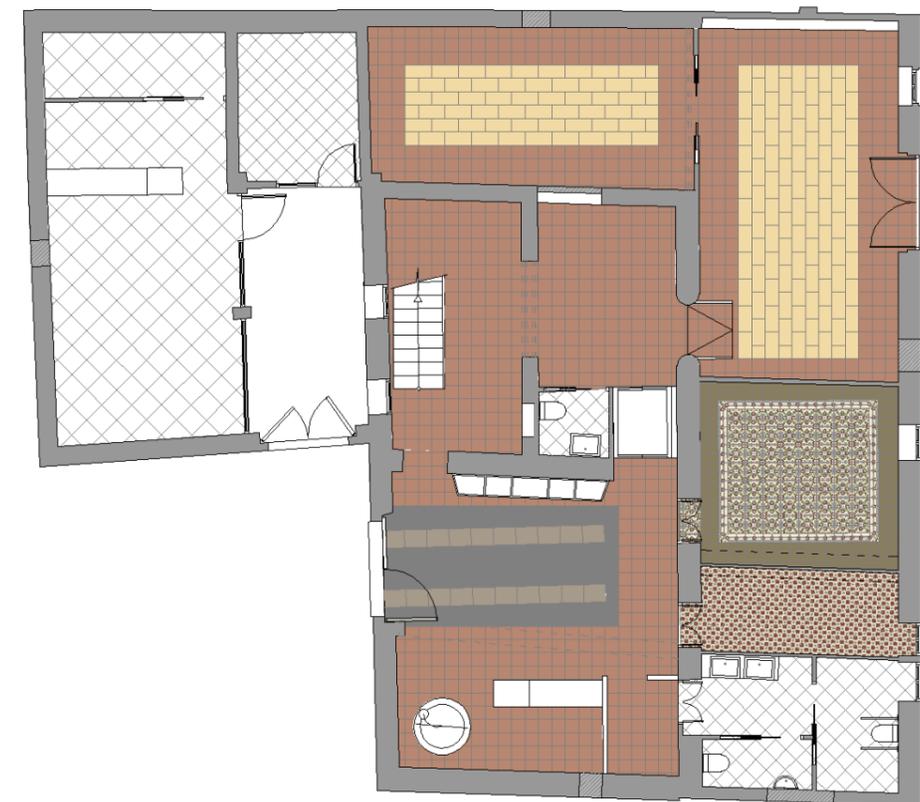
Vista del pavimento de la casa de campo ubicada en la finca "El Saytón" perteneciente a José Manuel Aparicio Sarrión y M^a Pilar García Moreno, tíos del autor del Proyecto. Fuente: Propio autor.
